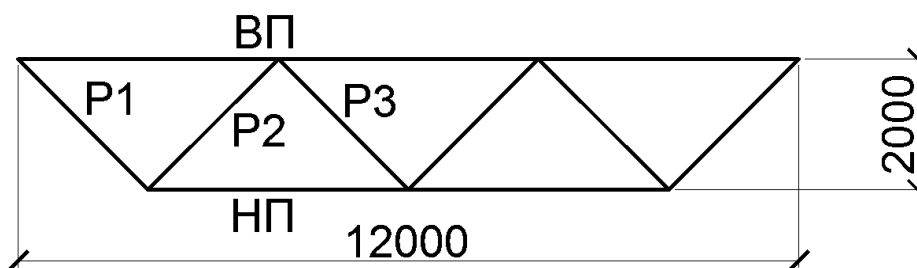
Обозначение стержней подстропильной фермы ПФ4
